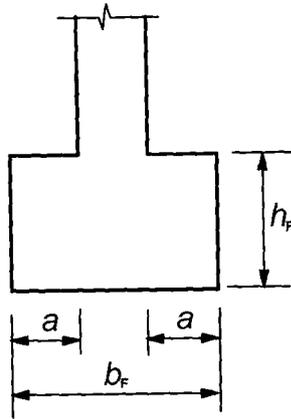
Unbewehrte Stützenfundamente; Bezeichnungen
